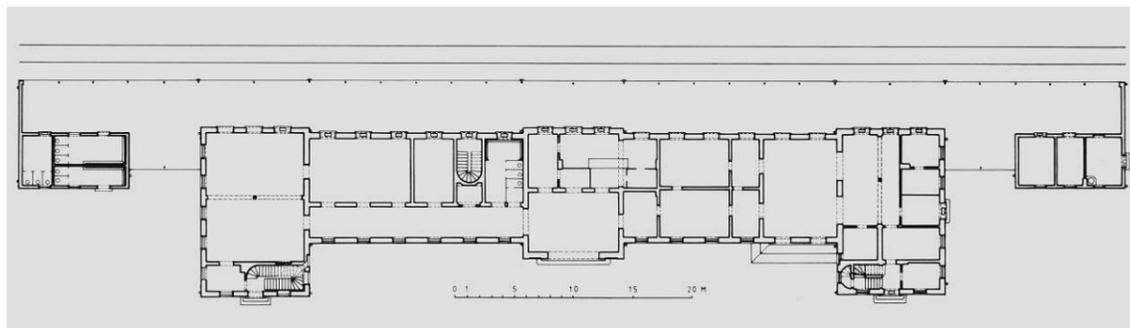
Ost-Bahnhof in Graz, Grundriss, 1873
